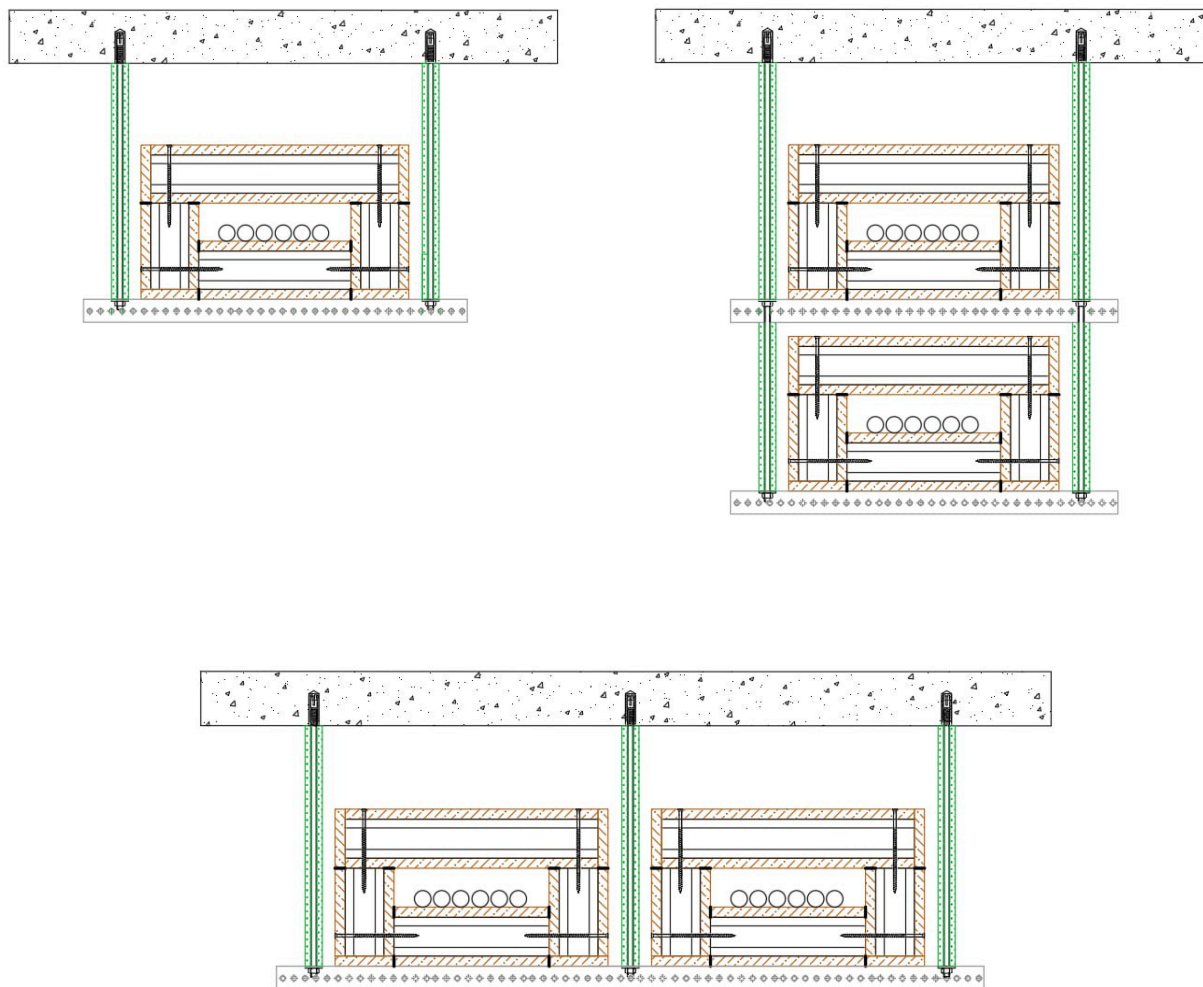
Крепление короба-лотка на подвесах к перекрытию
